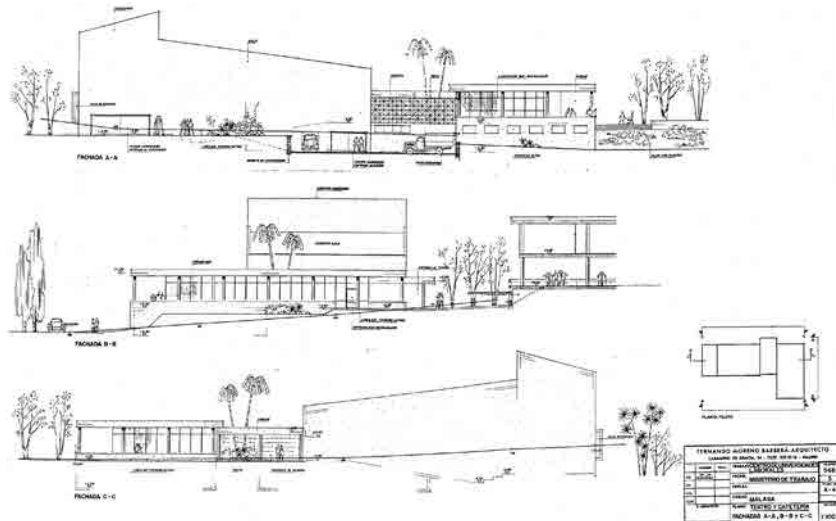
, Fig. 93 y Fig. 94 Propuesta previa: edificio del teatro-cafetería. Alzado de la fachada Sureste (arriba), alzado de la fachada Noreste (centro) y alzado de la fachada Noroeste (abajo).
